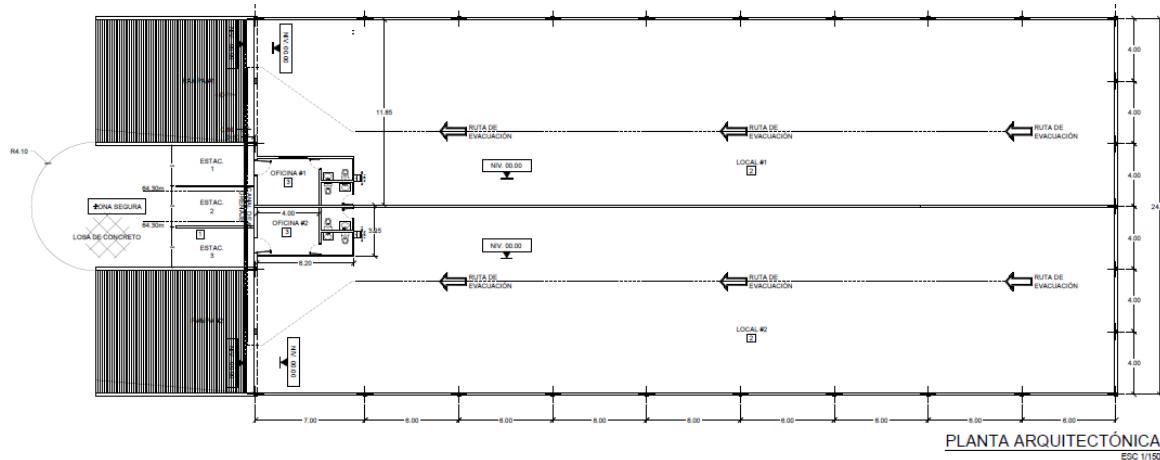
Esquema de la galera. Fuente Planos del proyecto, 2024.
